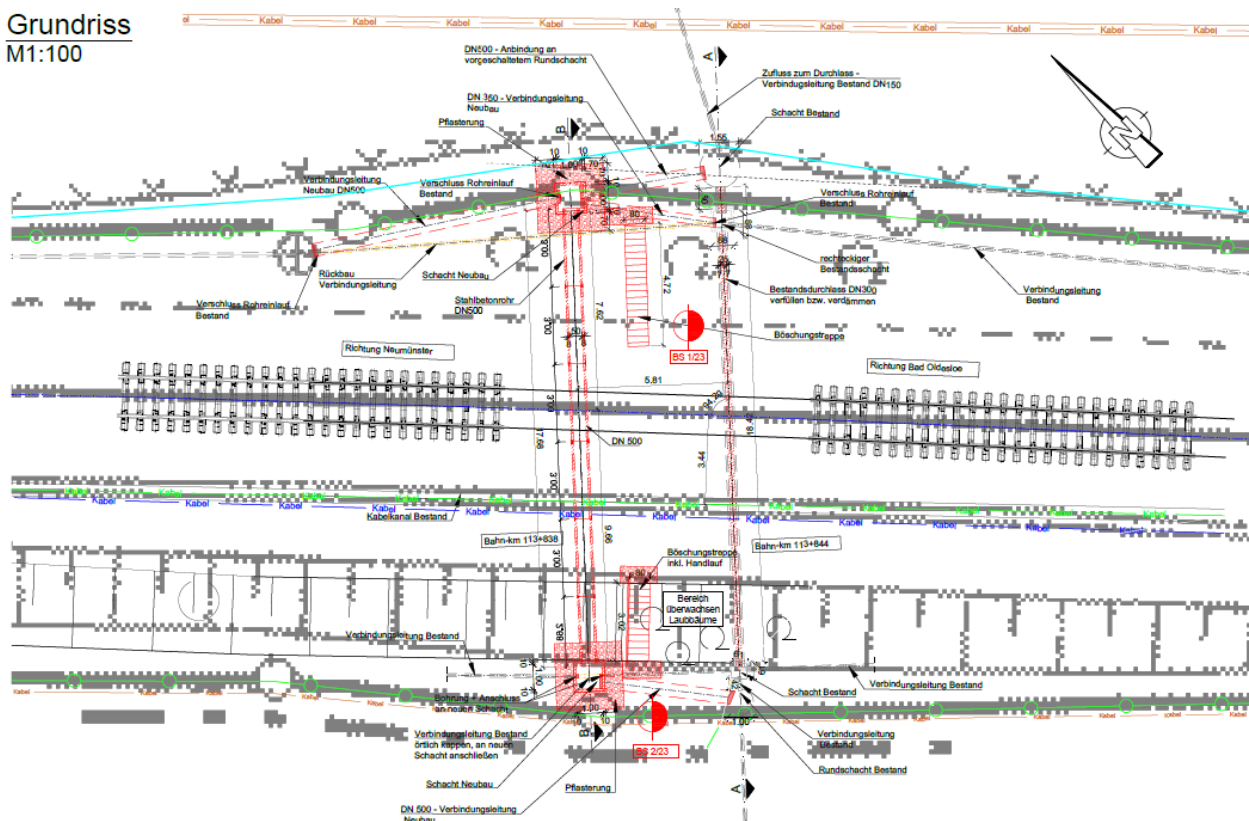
Grundriss des IST- und Planzustands des Durchlasses - Strecke 1043
